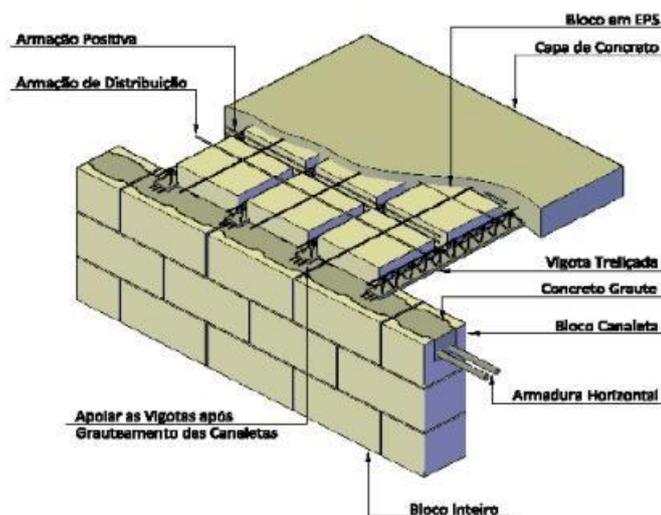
Representação laje em painel treliçado em alvenaria estrutural.
